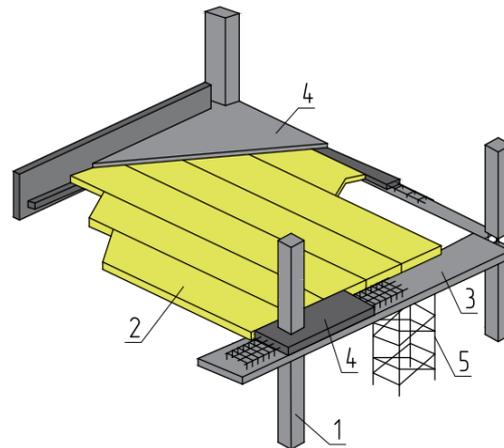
Устройство сборно-монолитного каркаса системы Dycore: 1 – колонна, 2 – сборная плита перекрытия; 3 – нижний сборный элемент балки; 4 – ее верхняя монолитная часть; 5 – пространственная поддерживающая рамная система
